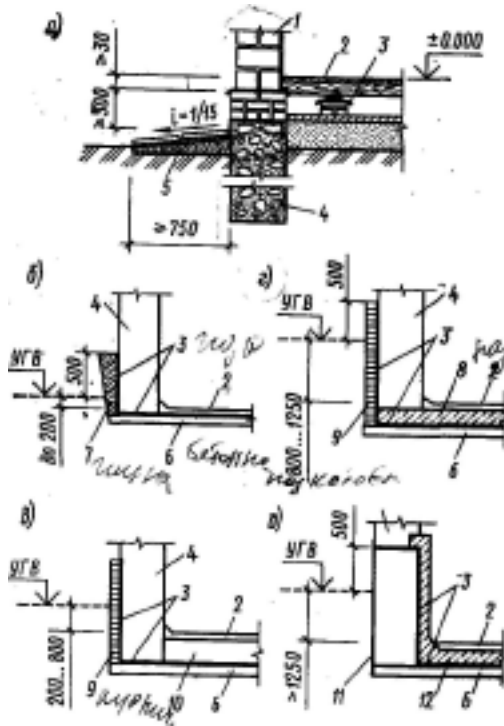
Защита элементов малоэтажных зданий от влаги грунтов:
